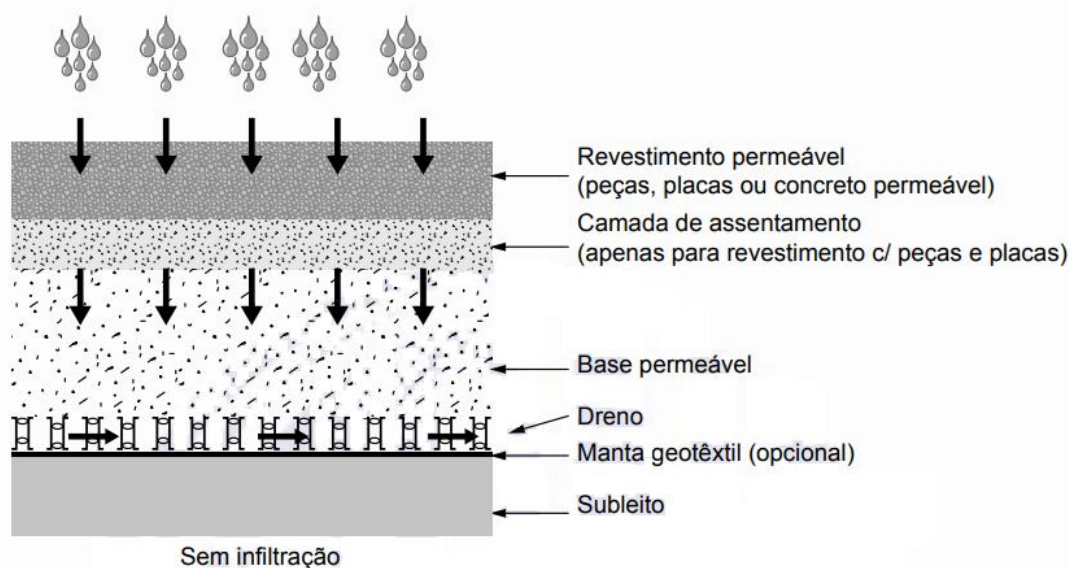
Exemplo de sistema de pavimento permeável sem infiltração apresentado na NBR 16416.
